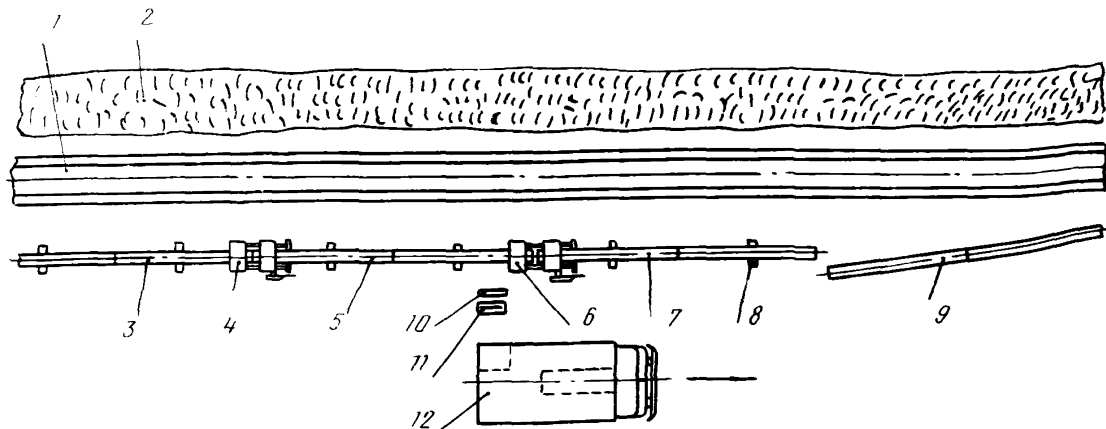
Схема организации сварочного поста при сварке трубопровода в непрерывную нитку с двумя центраторами:
